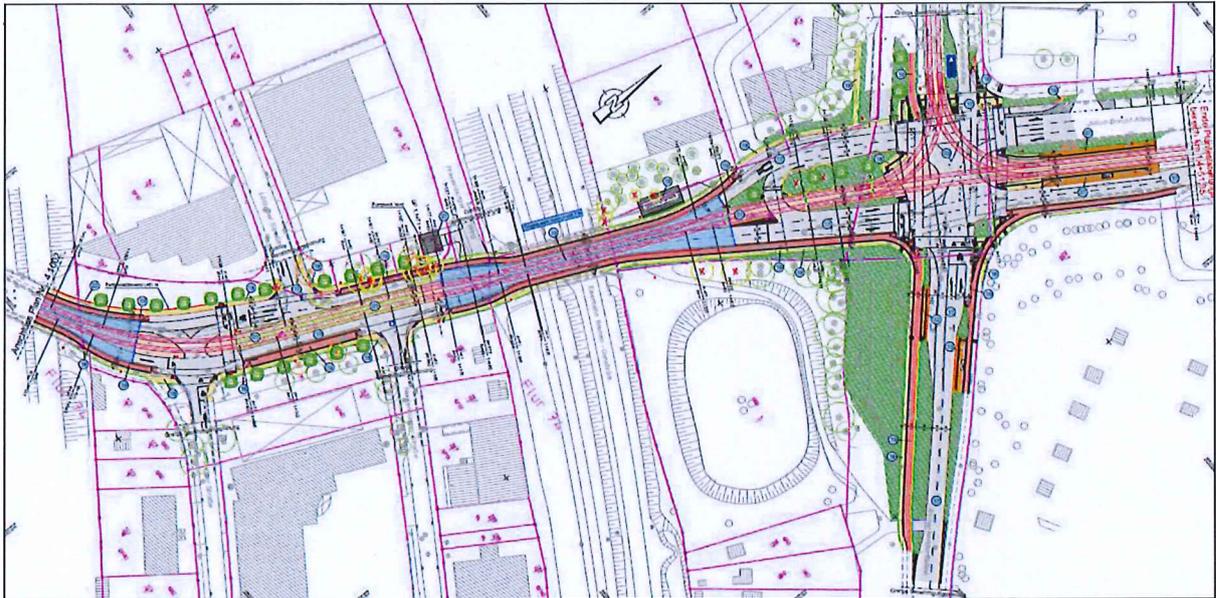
Lageplan Vorzugsvariante Steubenstraße bis Anschluss Konrad-Adenauer- / Julius-Brecht-Allee
